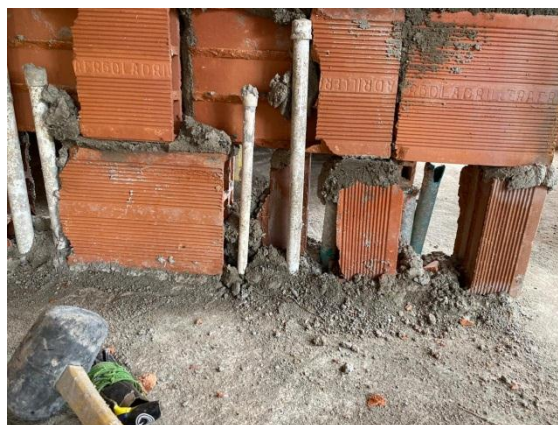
Cortes de ladrillo para replanteo. Elaboración propia.
